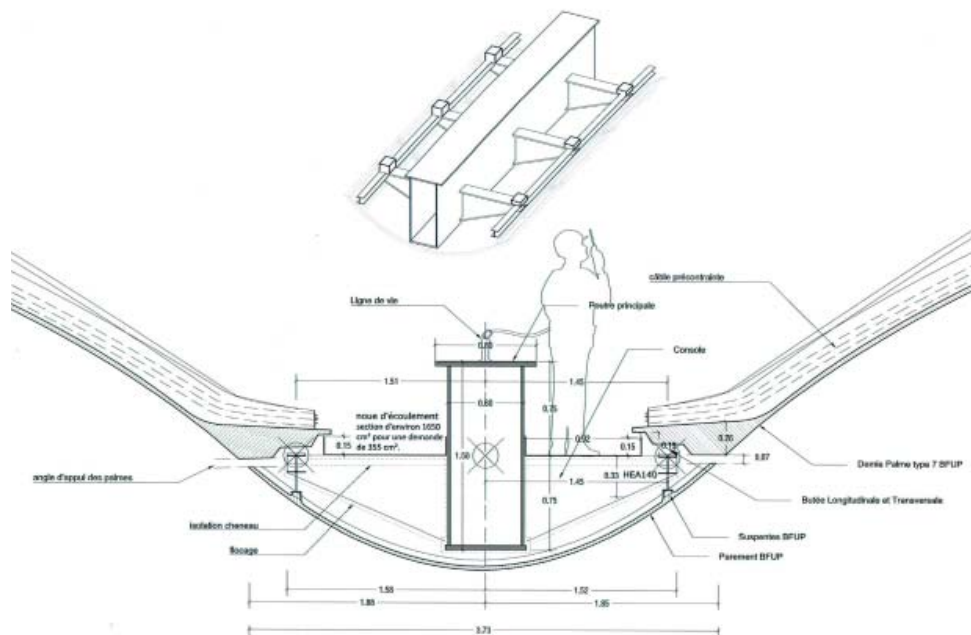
Detall de la secció longitudinal. Suport de les plaques d'UHPC a les jàsseres metàl·liques.
